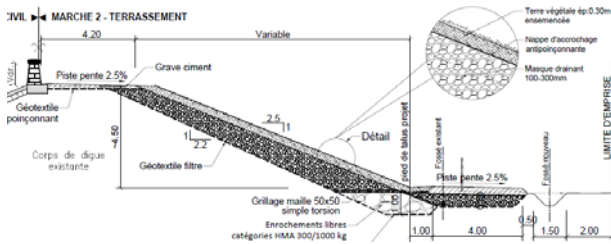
COUPE DES TRAVAUX SUR LE PAREMENT AVAL - SOURCE : BRLI
